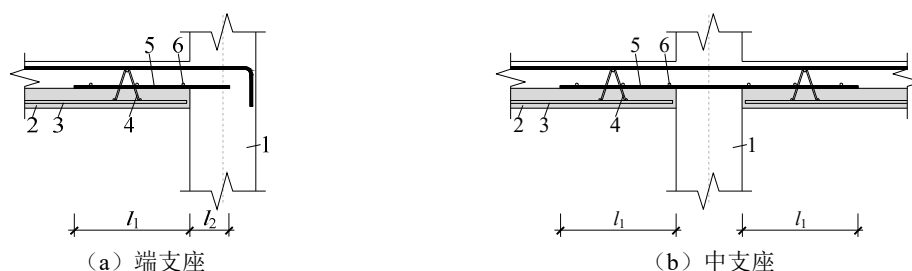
桁架预制板纵向钢筋不伸入支座构造示意
